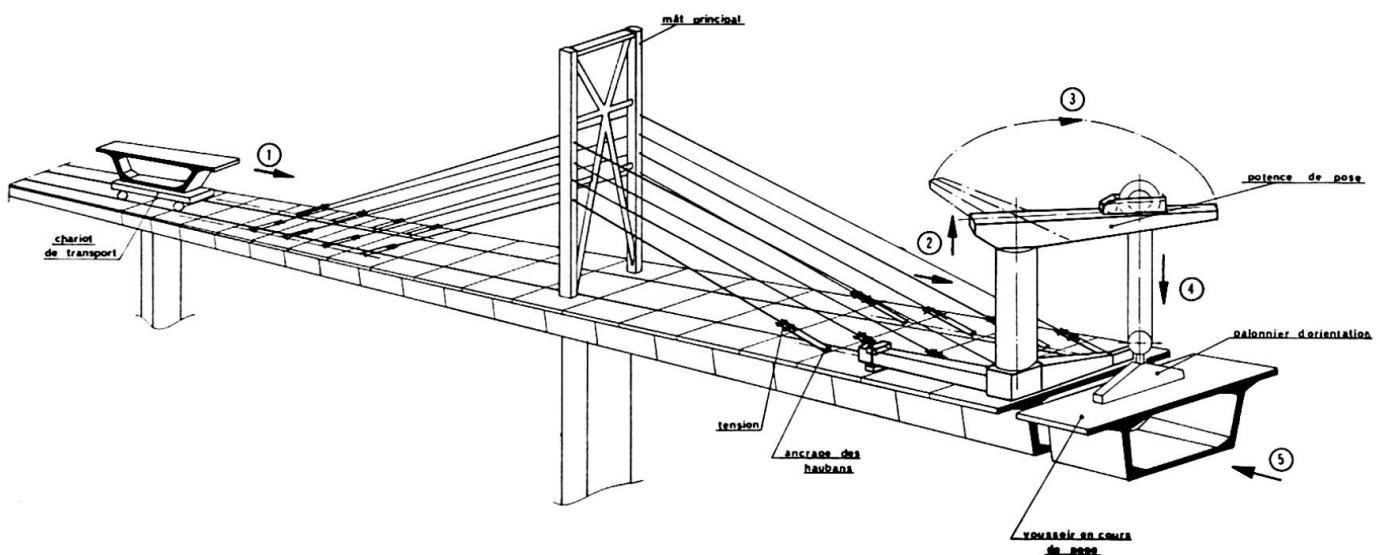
CONSTRUCTION A L'AVANCEMENT
